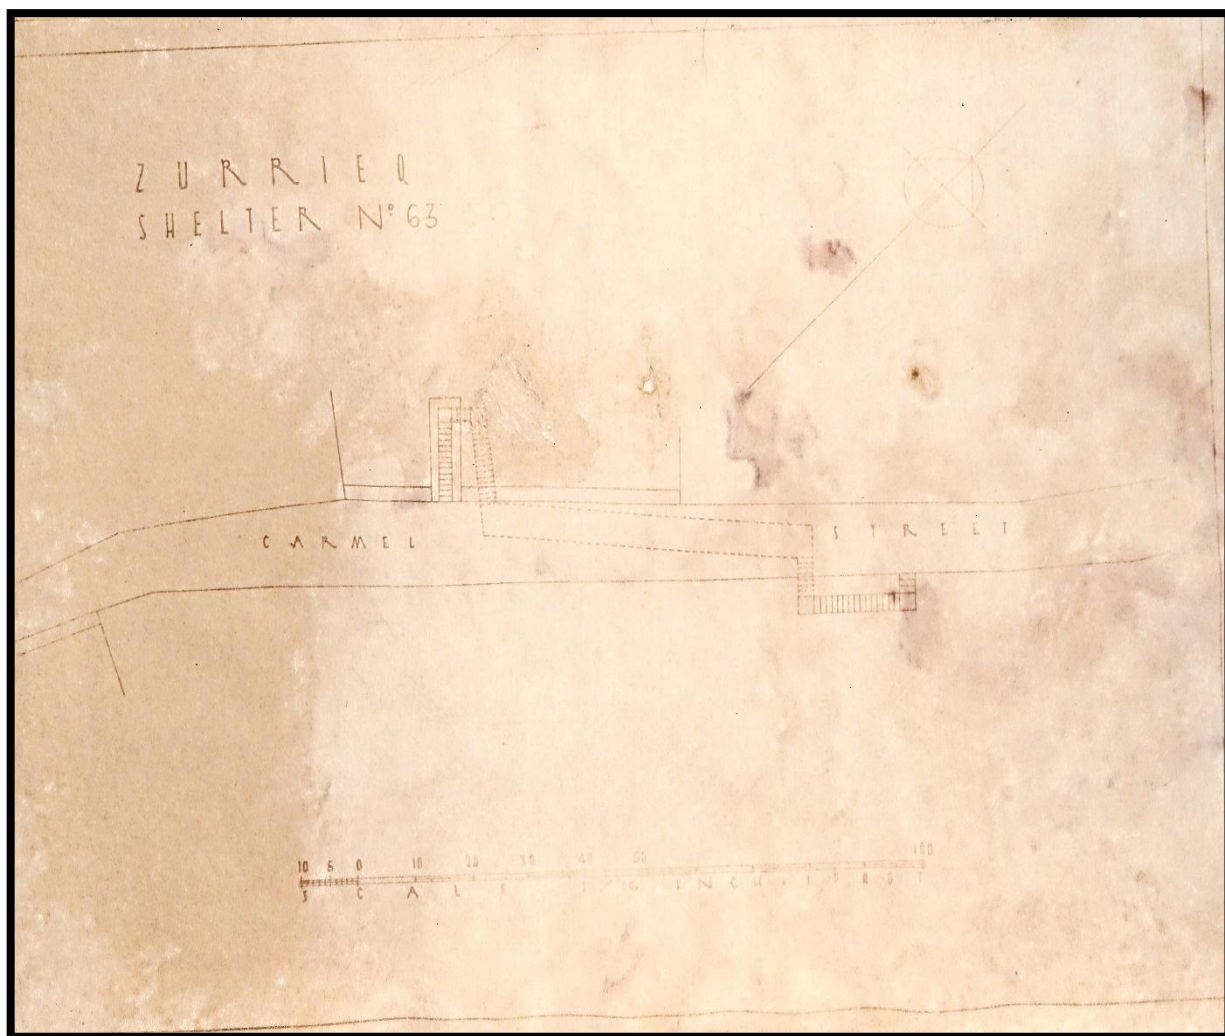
Planta do Abrigo nº63 "Carmel Street"
